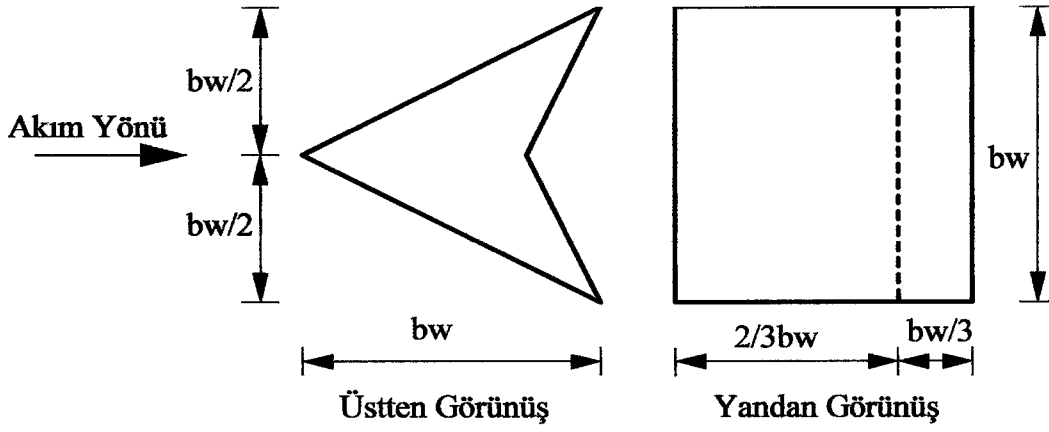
Deneyde kullanılan 16. tip enerji kırıcı blok
